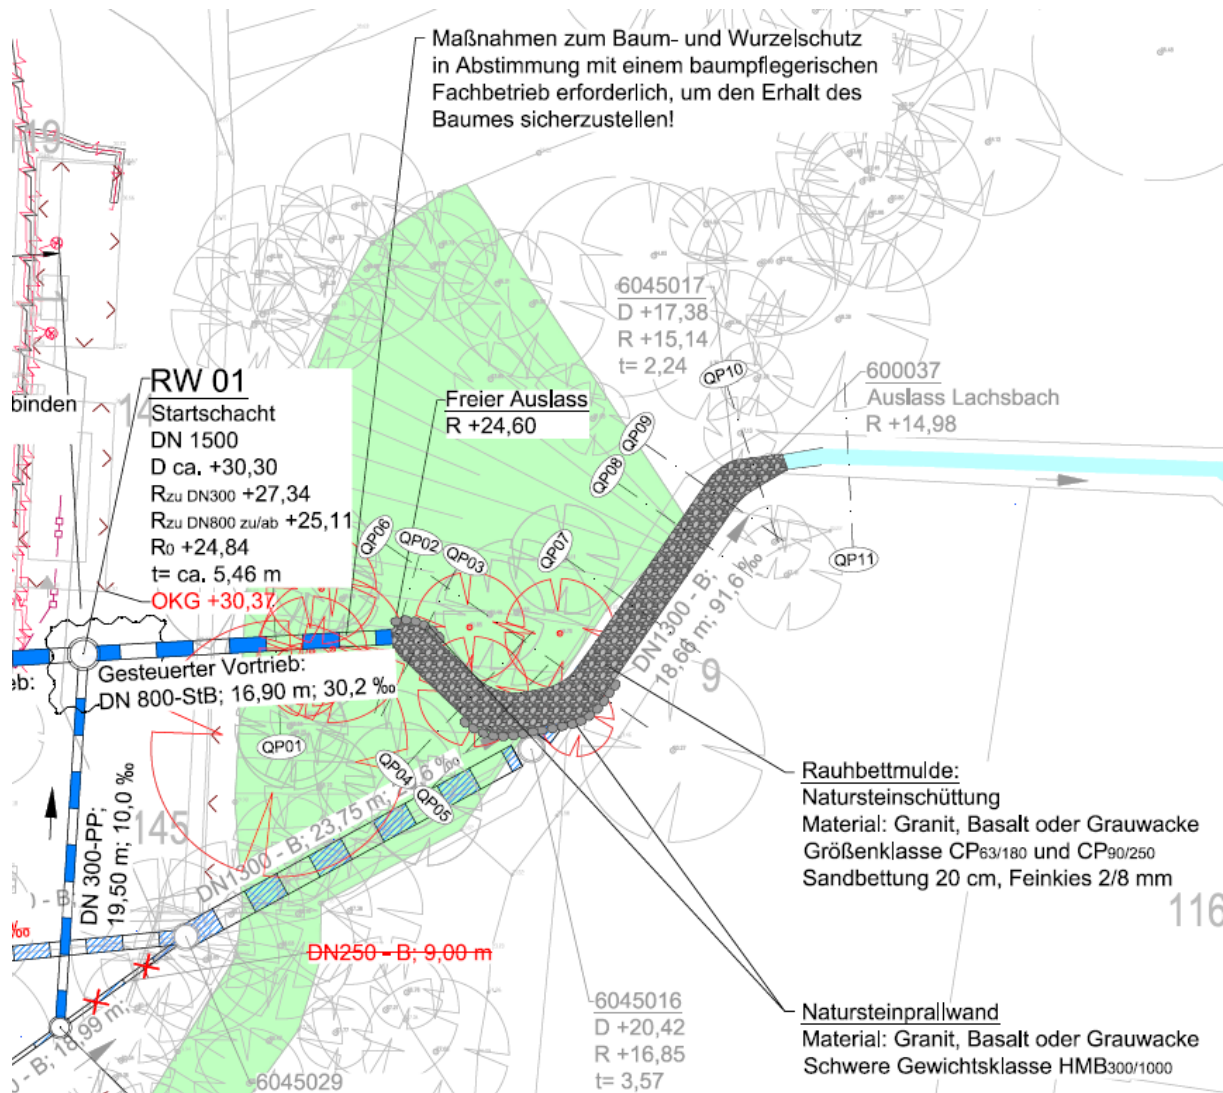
Ausschnitt Lageplan der Vorzugsvariante (Masuch + Olbrisch 2025b)
